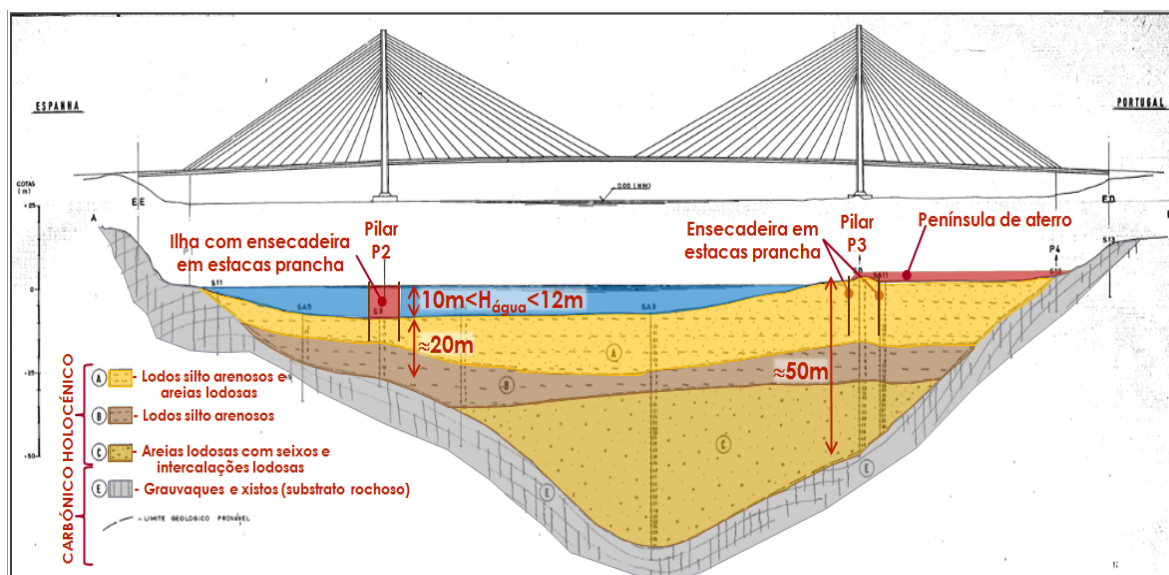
Corte longitudinal ilustrando a implantação da ponte sobre o perfil geológico interpretativo e as estruturas de acesso concebidas para execução das infraestruturas da ponte
